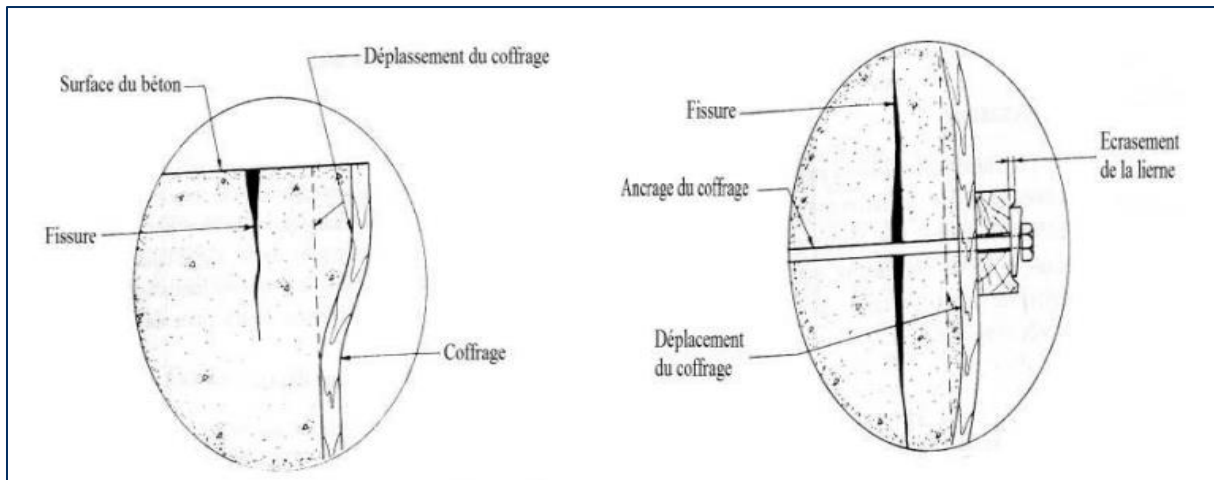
Fissure due aux mouvements des coffrages pendant la prise du béton
